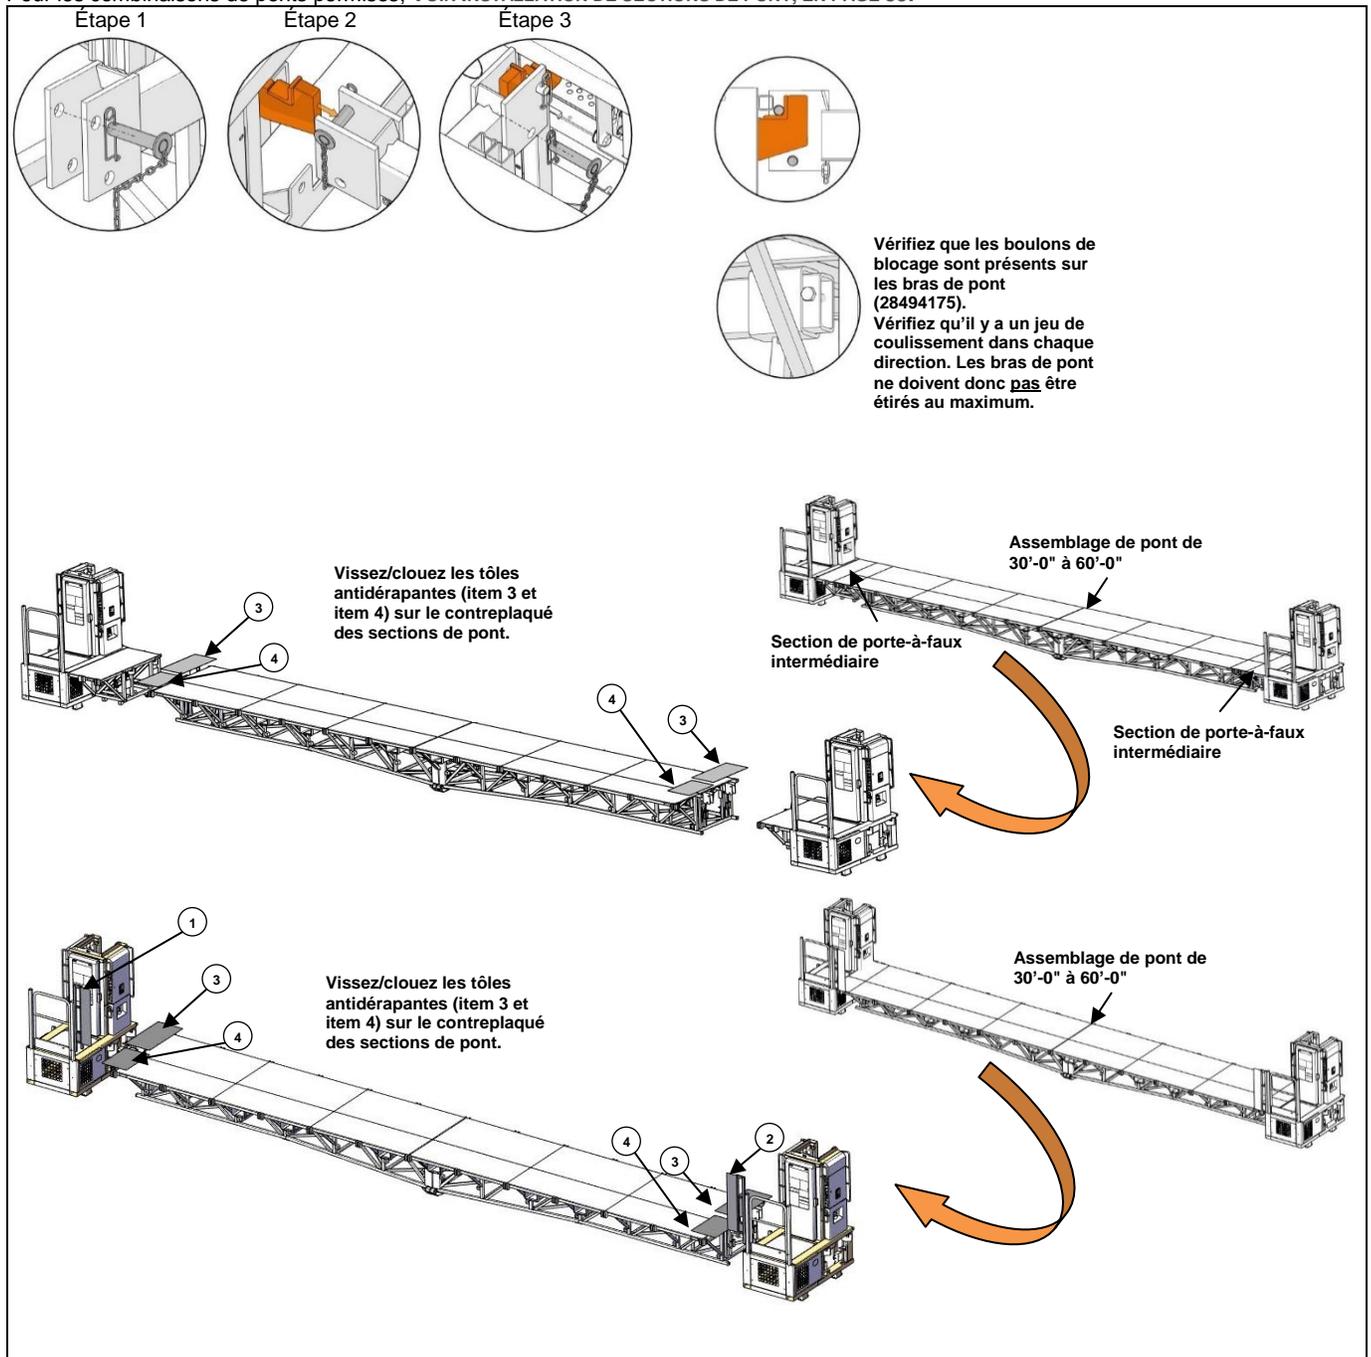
Installation d'assemblage de pont 30'-0" à 60'-0" sur unité élévatrice et/ou PAF intermédiaire
